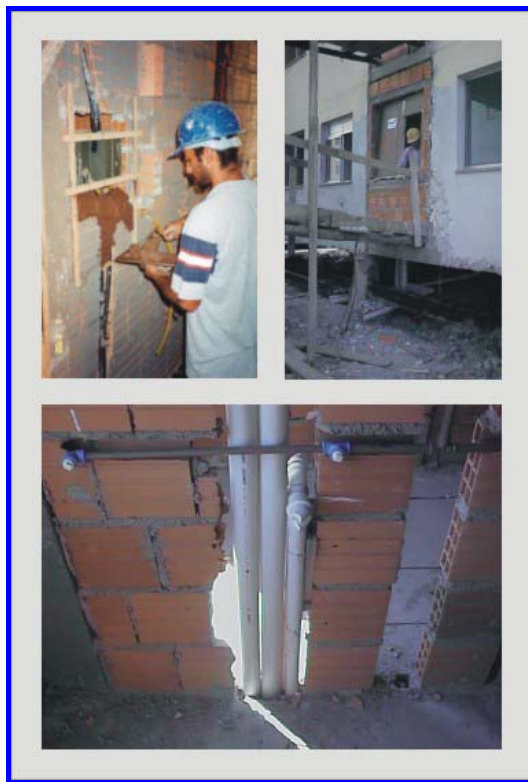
Serviços intermediários entre alvenaria e reboco de parede
